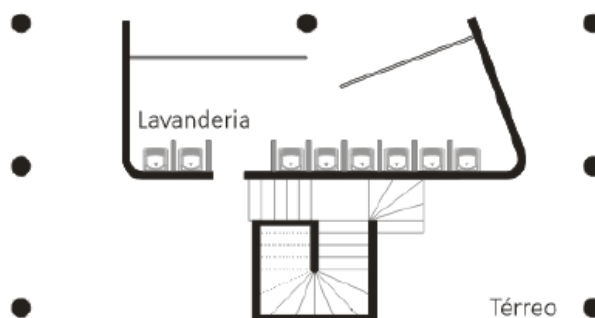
Planta baixa IAPI, unidade Mínima (M)
